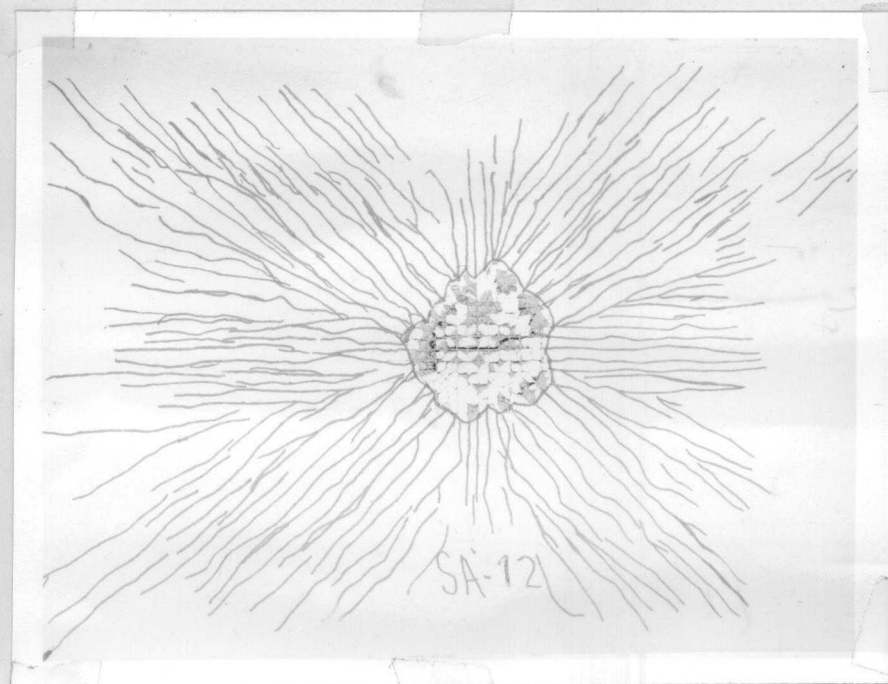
Configuração de ruína (face inferior) da Laje SA-12.
